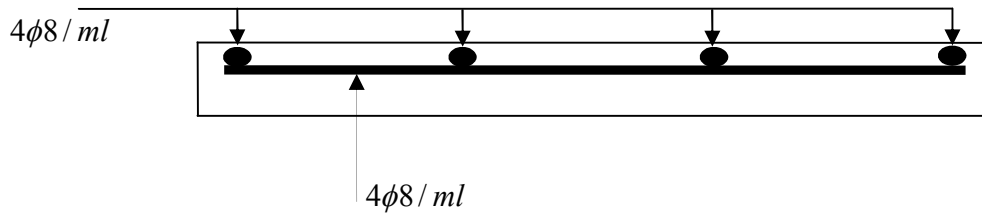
Schéma de ferrailage de la dalle sur deux appuis.
